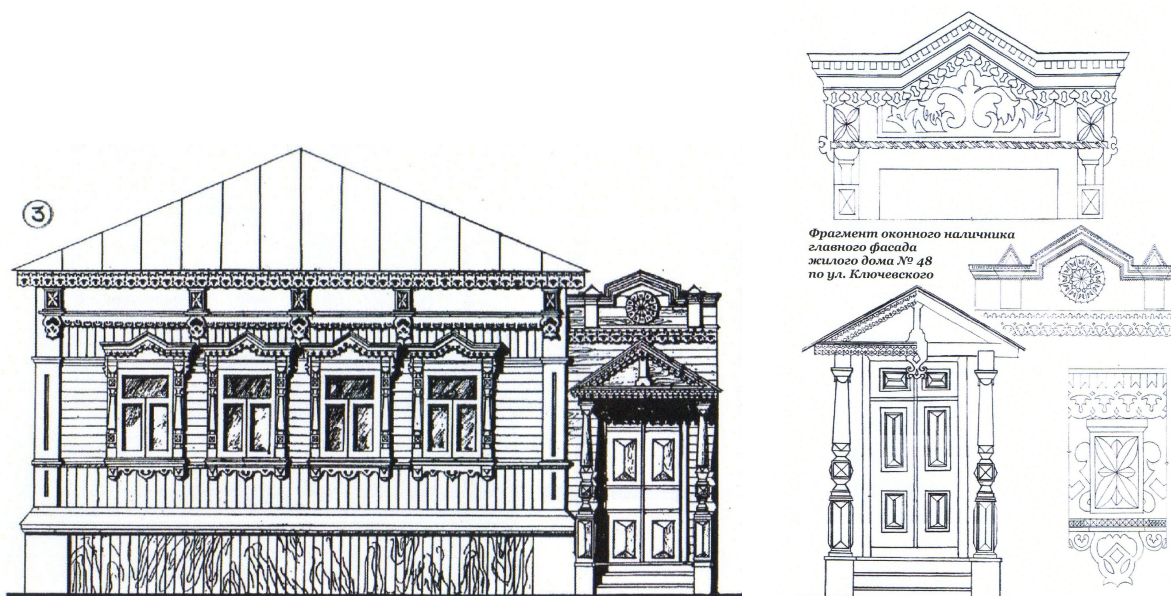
Ул. Ключевского, 48. Главный фасад. Элементы фасада.
